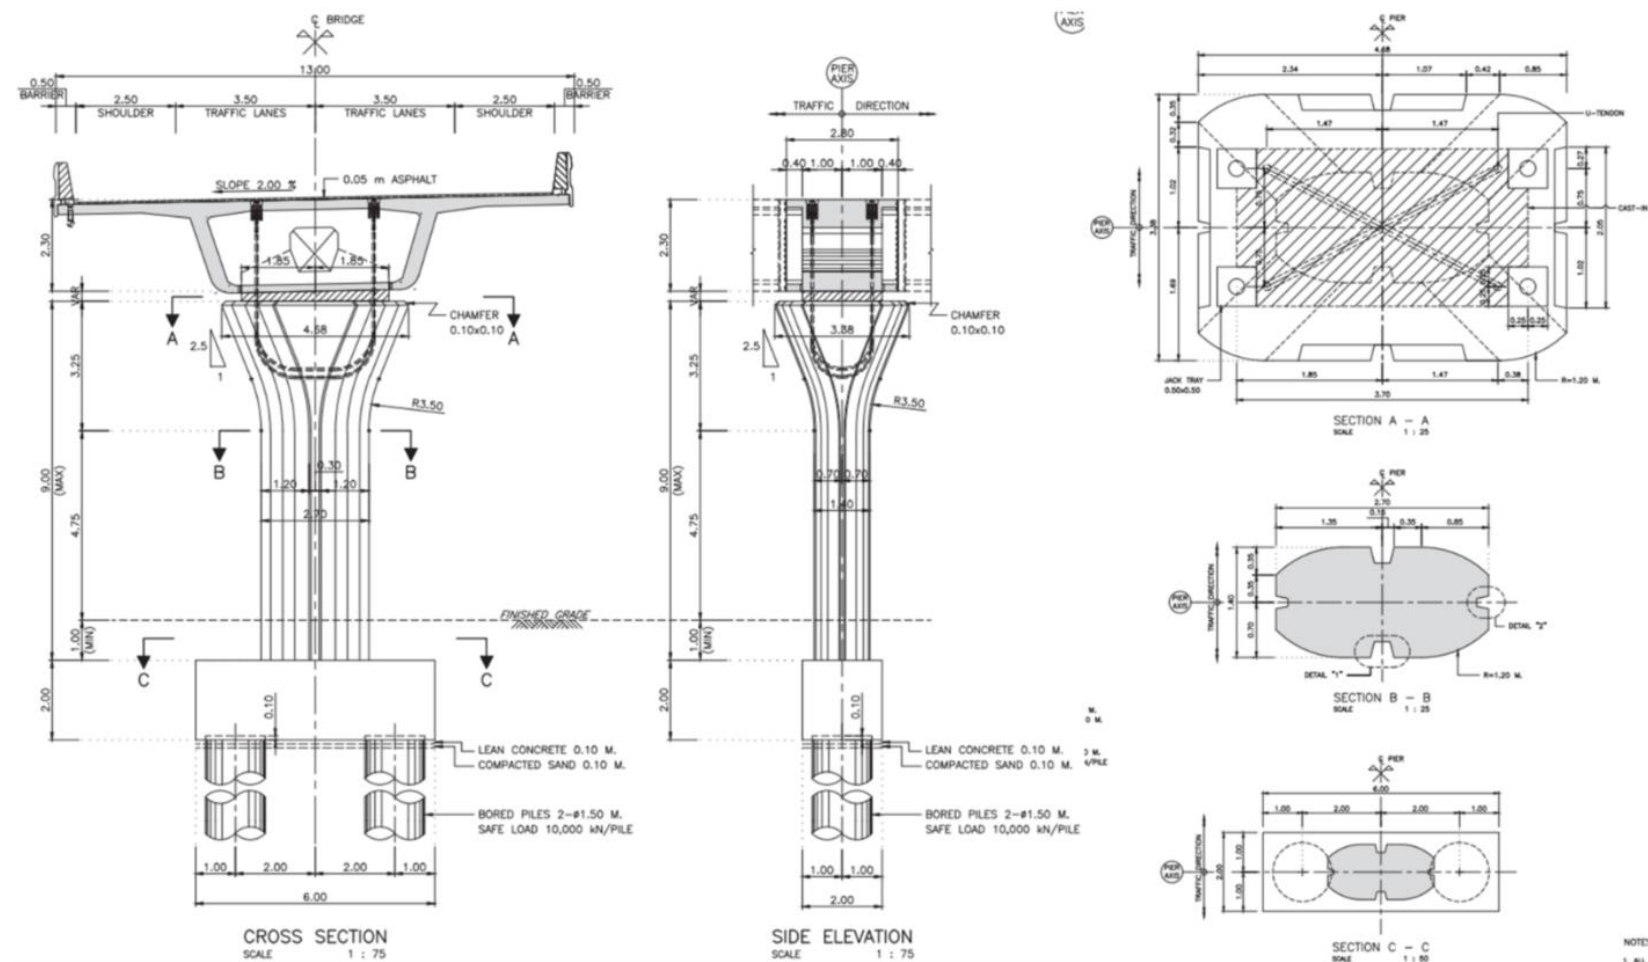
ตัวอย่าง LAYOUT สะพานคานยื่นสมดุล (Balance Cantilever Bridge)
